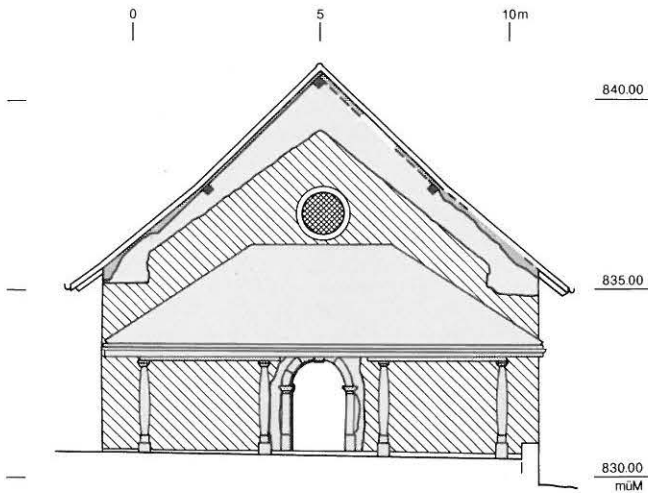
Boltigen, Kirche. Westfassade mit Bauphasen. M. 1:200. Legende s. Abb. 177.
